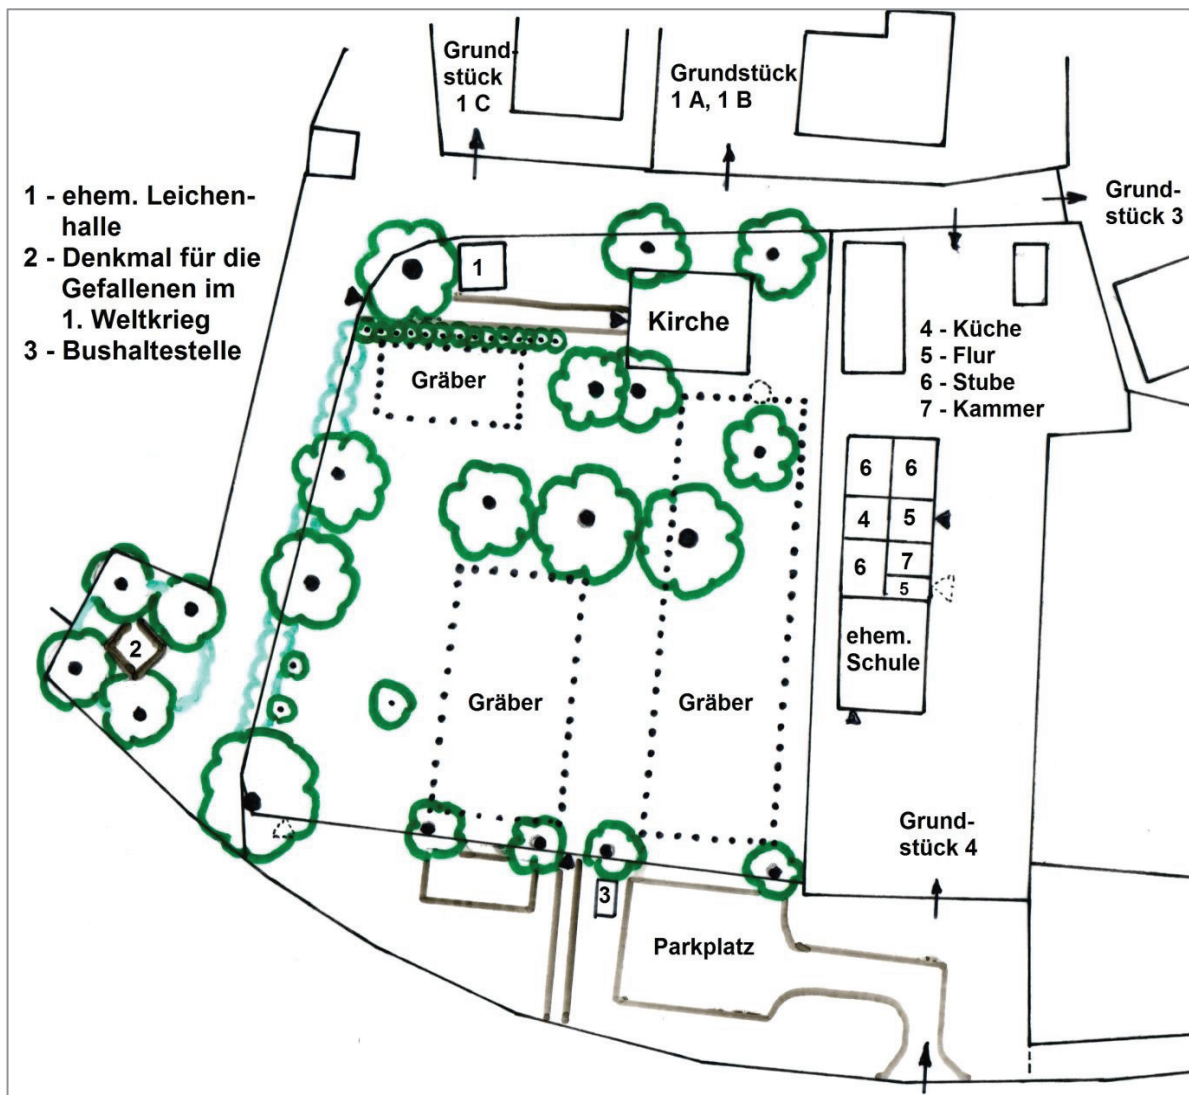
Lageplan Kirchhof Lübkwow (Skizze ohne Maßstab) mit Grundriss der ehem. Schule
